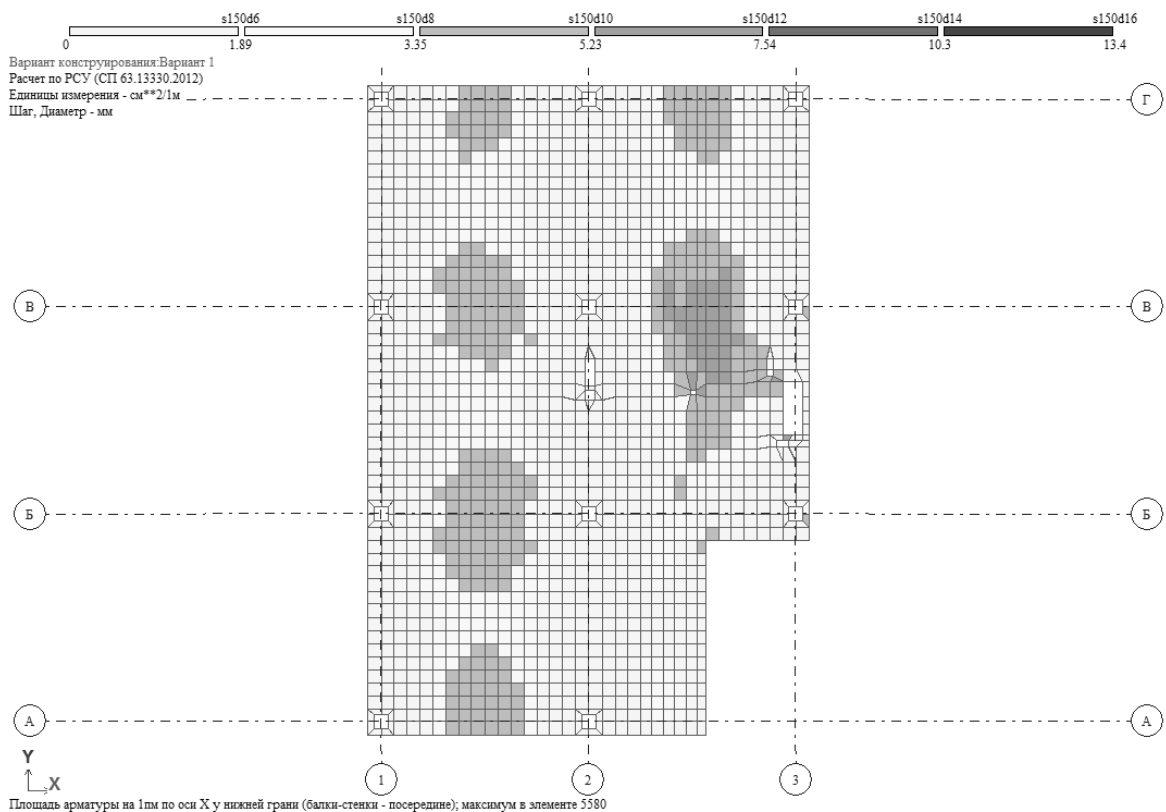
Армирование плит перекрытия по оси X у нижней грани
